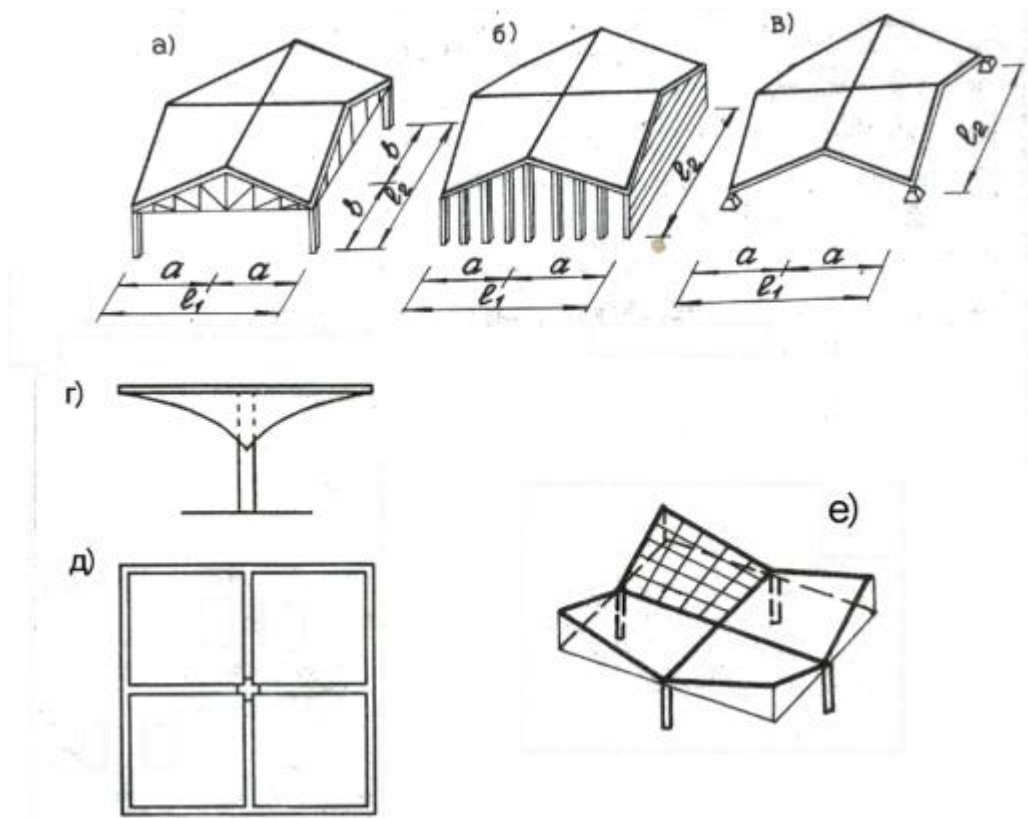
Залізобетонні гіпари на квадратному плані:
